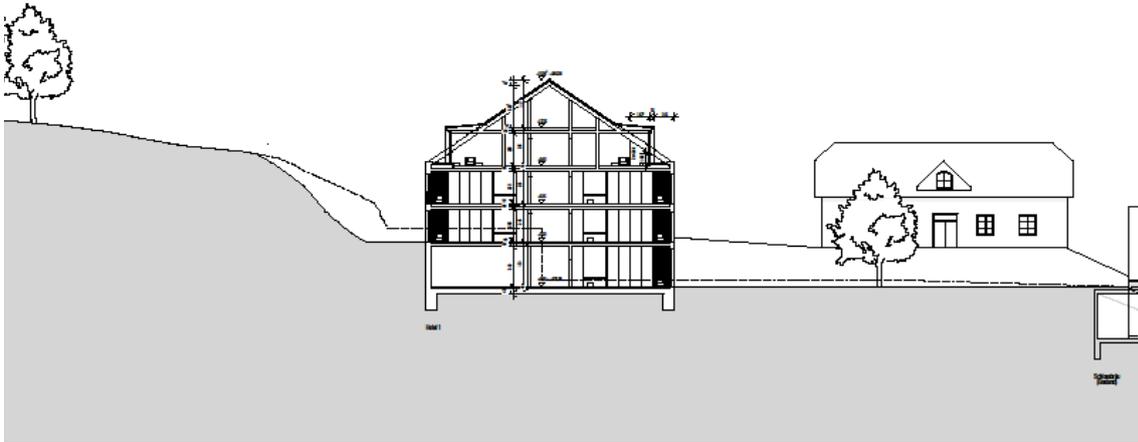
Schnitt CC, Neubau-Hotel Haus 1 mit Blick auf Waschhaus
